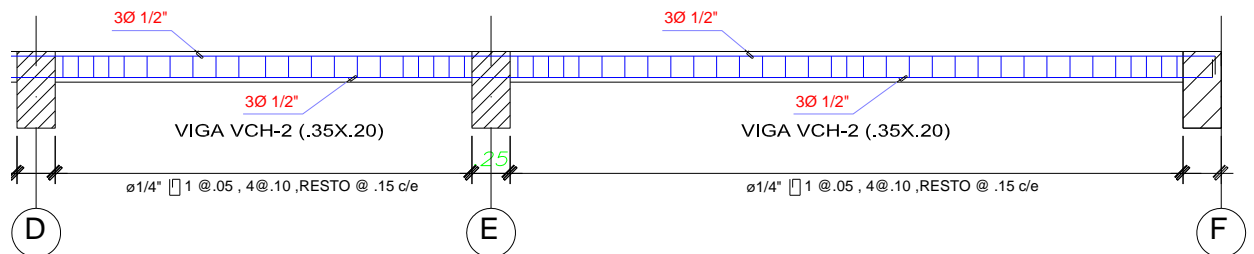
Detalle del Acero en la viga Chata 35x20 (segunda parte)
